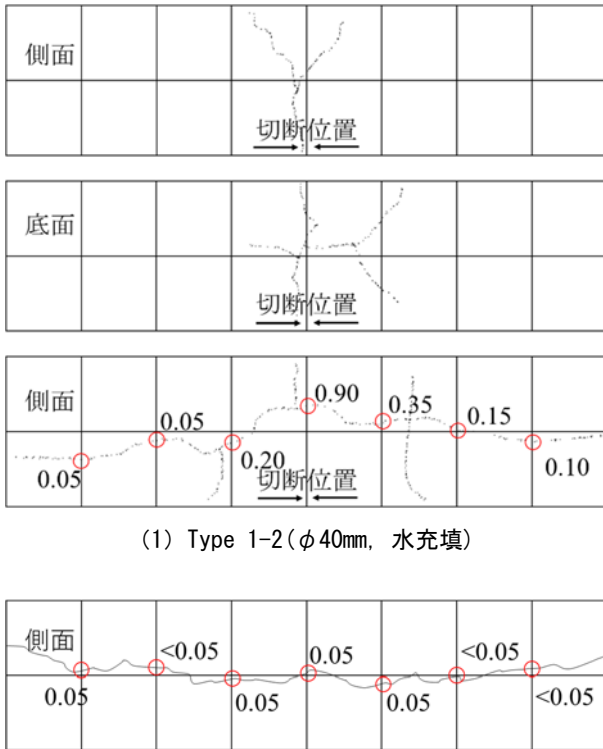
ひび割れ図（ひび割れ発生面のみ、
